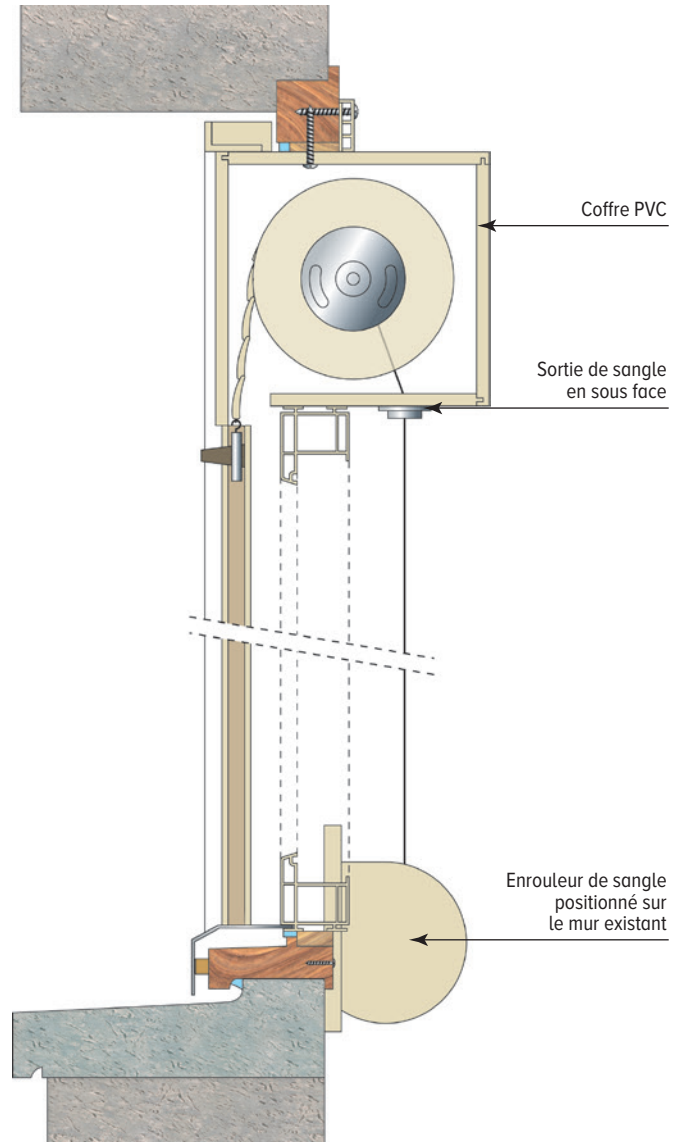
Coupe verticale pour une pose en rénovation sur dormant existant avec enroulement intérieur. Exemple d'une sortie de sangle en sous-face du coffre.
